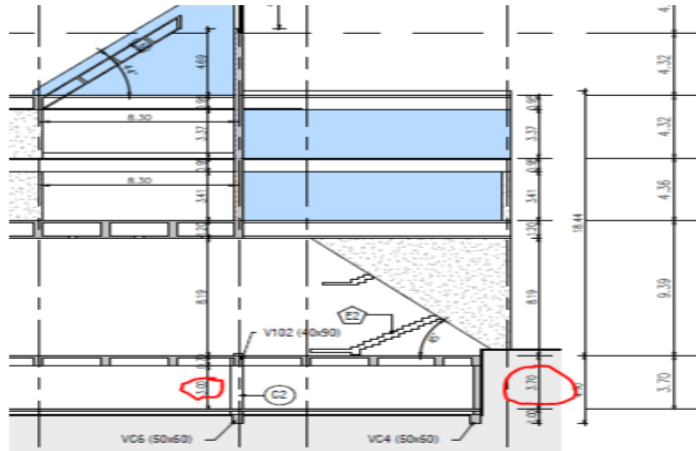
Extracto de la vista del corte estructural del sótano 1
